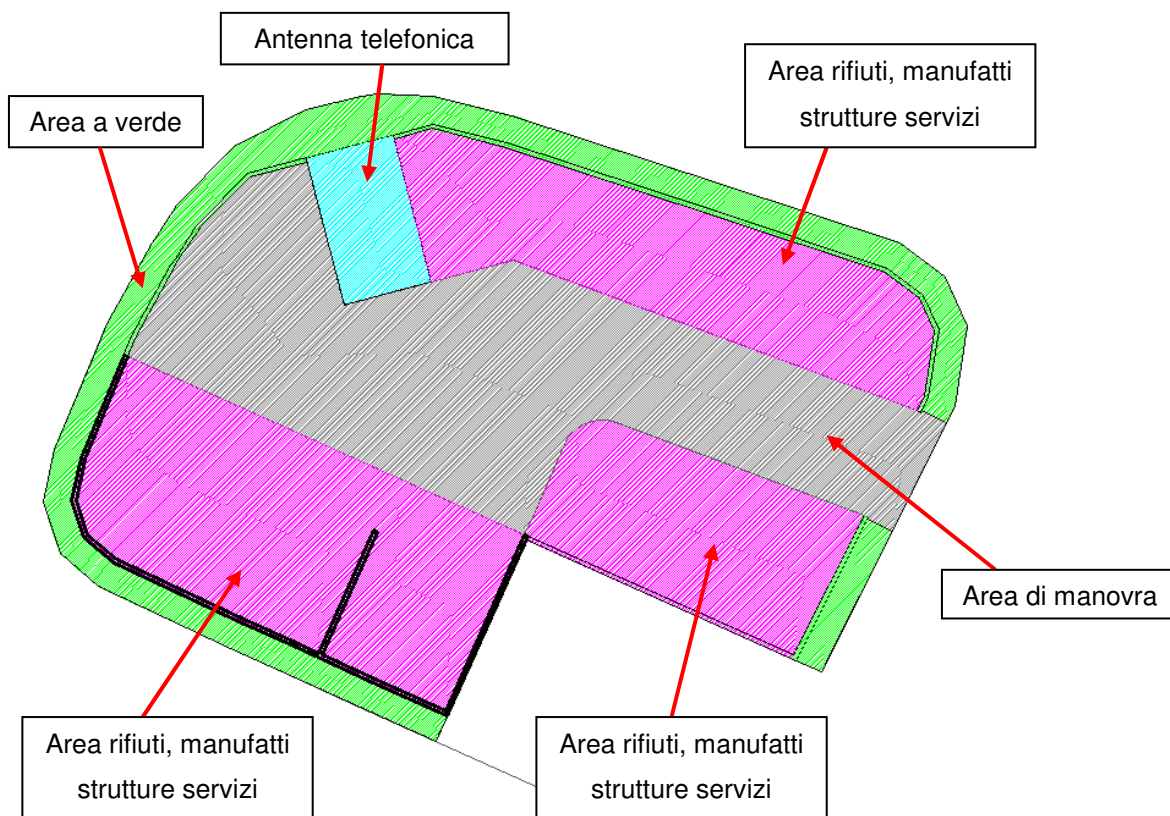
Suddivisione aree piazzola CdR di progetto
